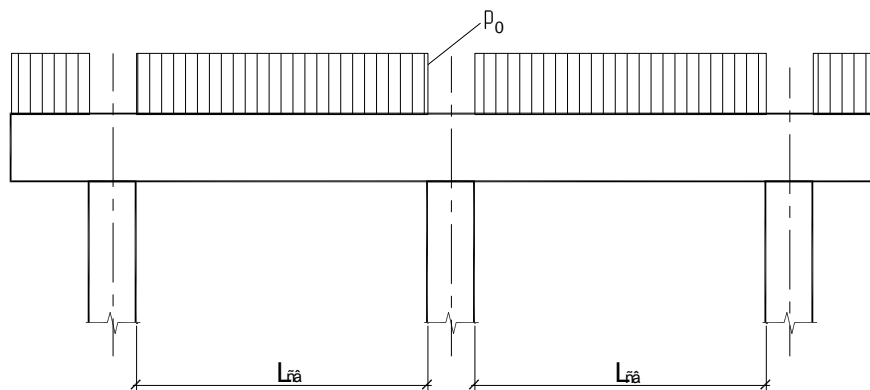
Схема к определению нагрузки на ростверк
